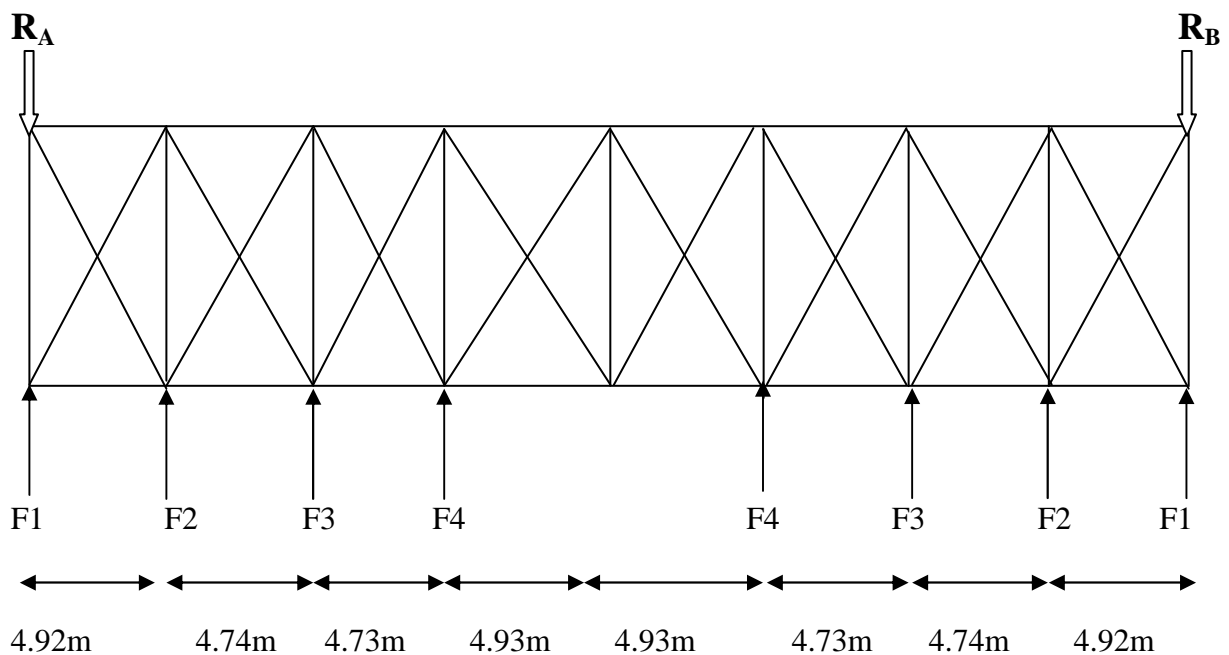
Schéma statique de la poutre au vent en pignon.
